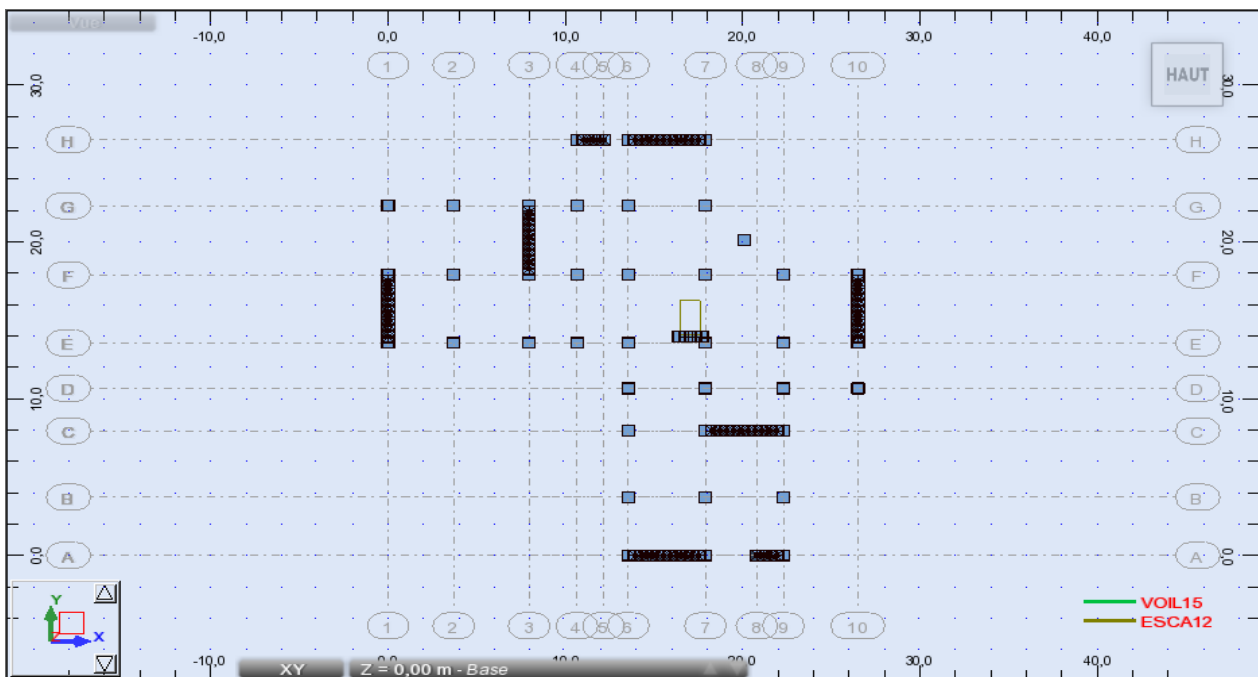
La 3ème disposition des murs voiles et poteaux
